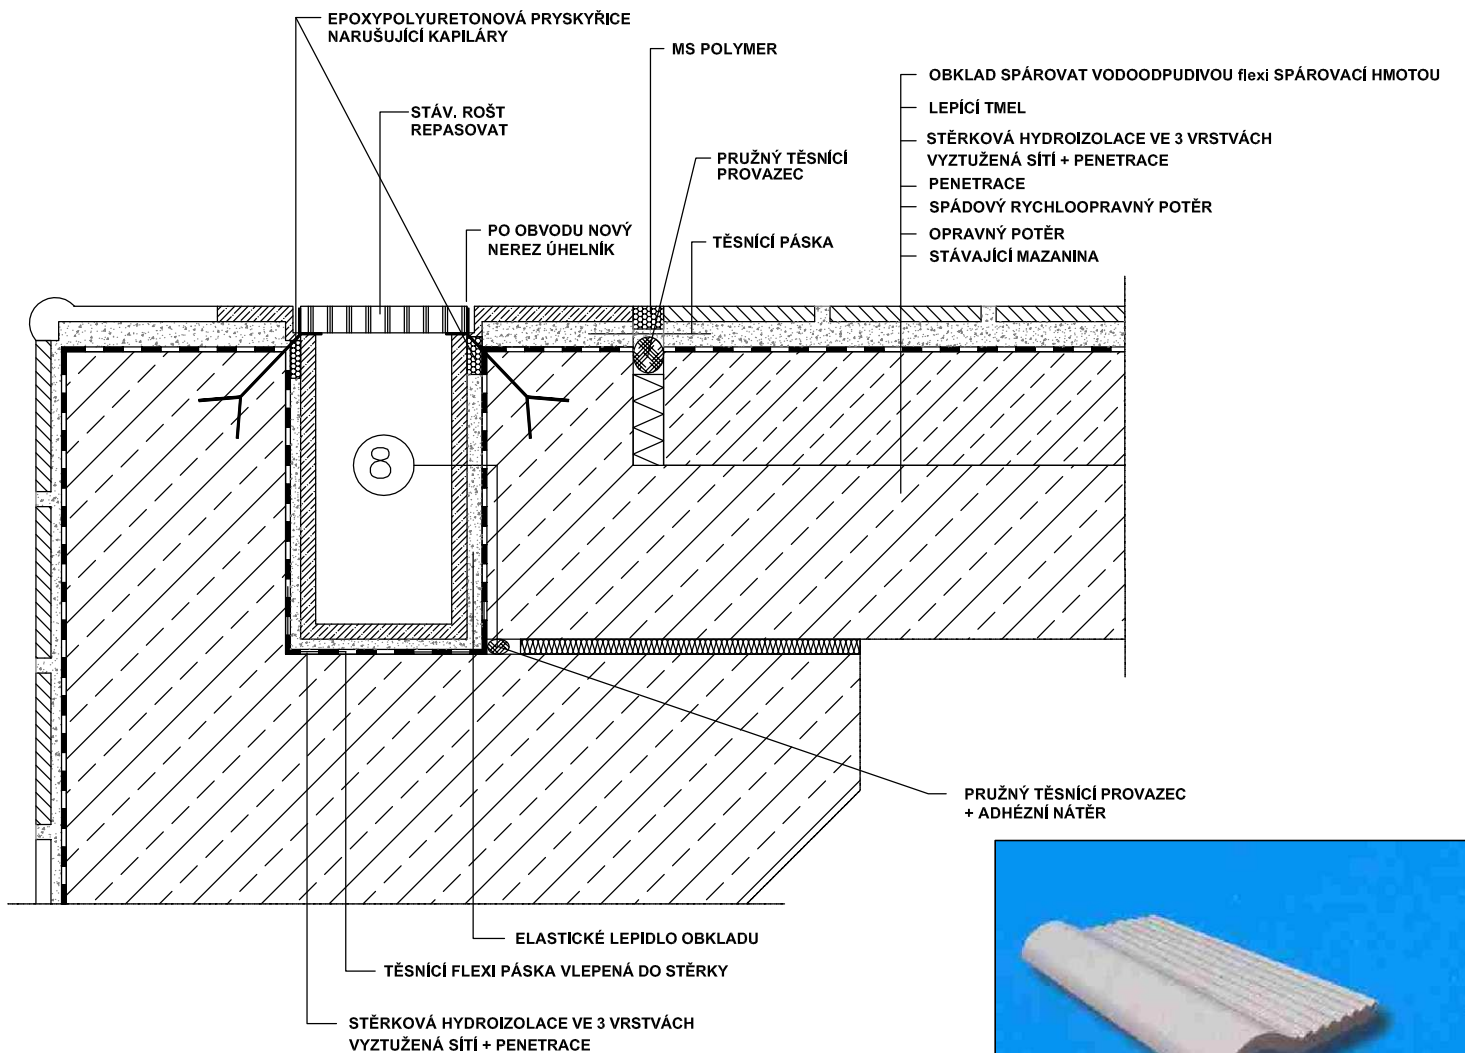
DETAIL DILATAČNÍ SPÁRY POD OBKLADEM
